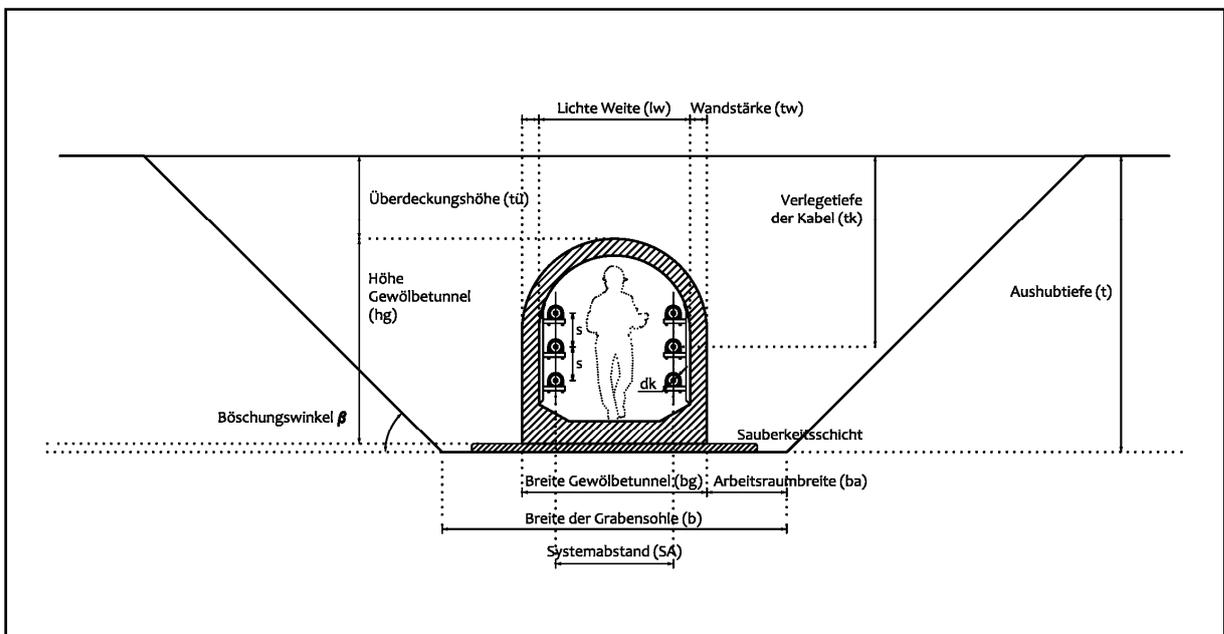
Geometrie der Variante 3A-G, Verlegung im oberflächennahen Gewölbetunnel
